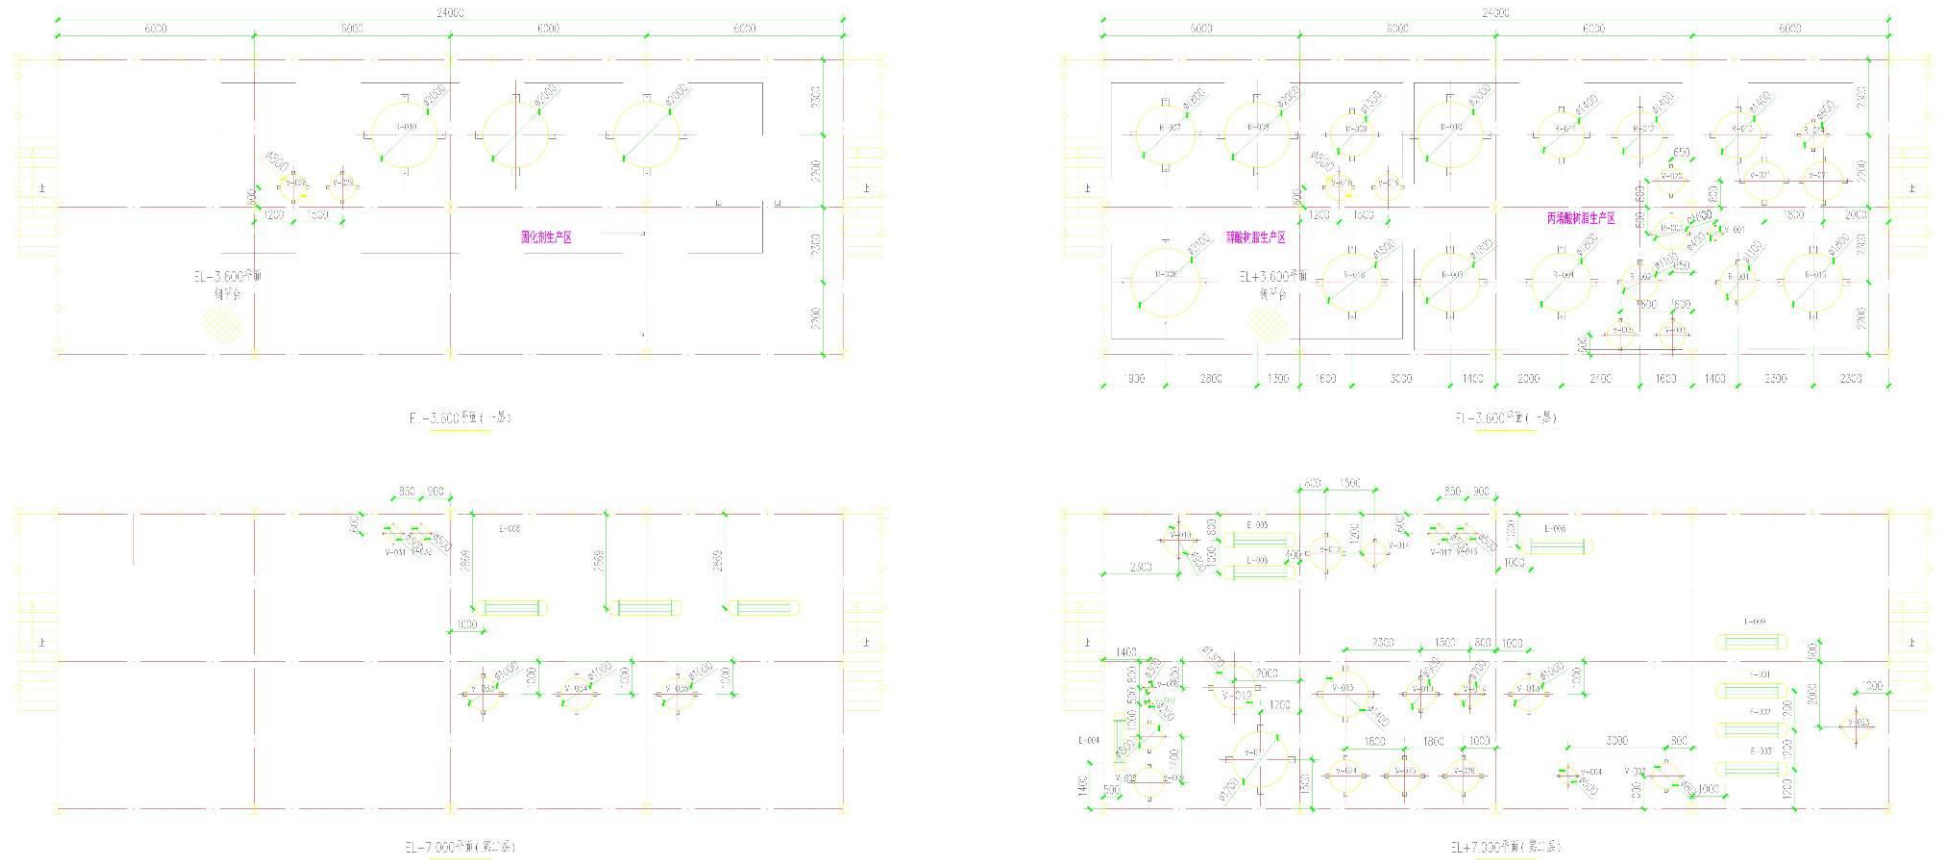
现有工程主体生产车间设备平面布置示意图
